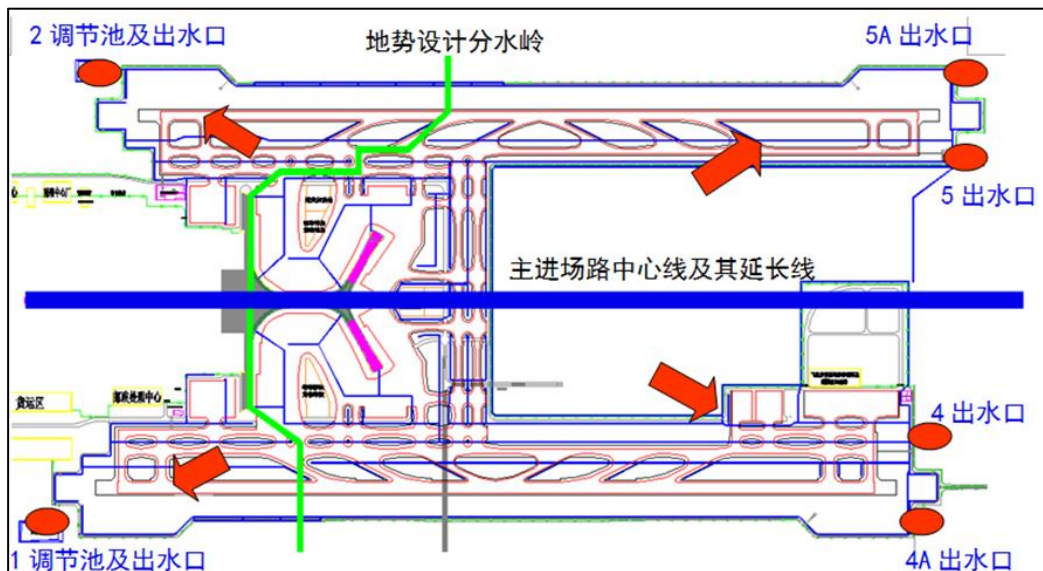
飞行区现状雨水分区及出口布置平面图
